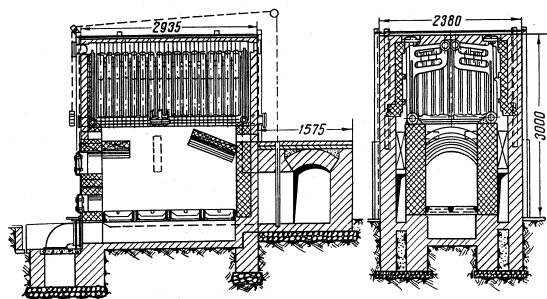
Габаритные размеры котла с поверхностью нагрева 43 м² с топкой для дров и торфа
